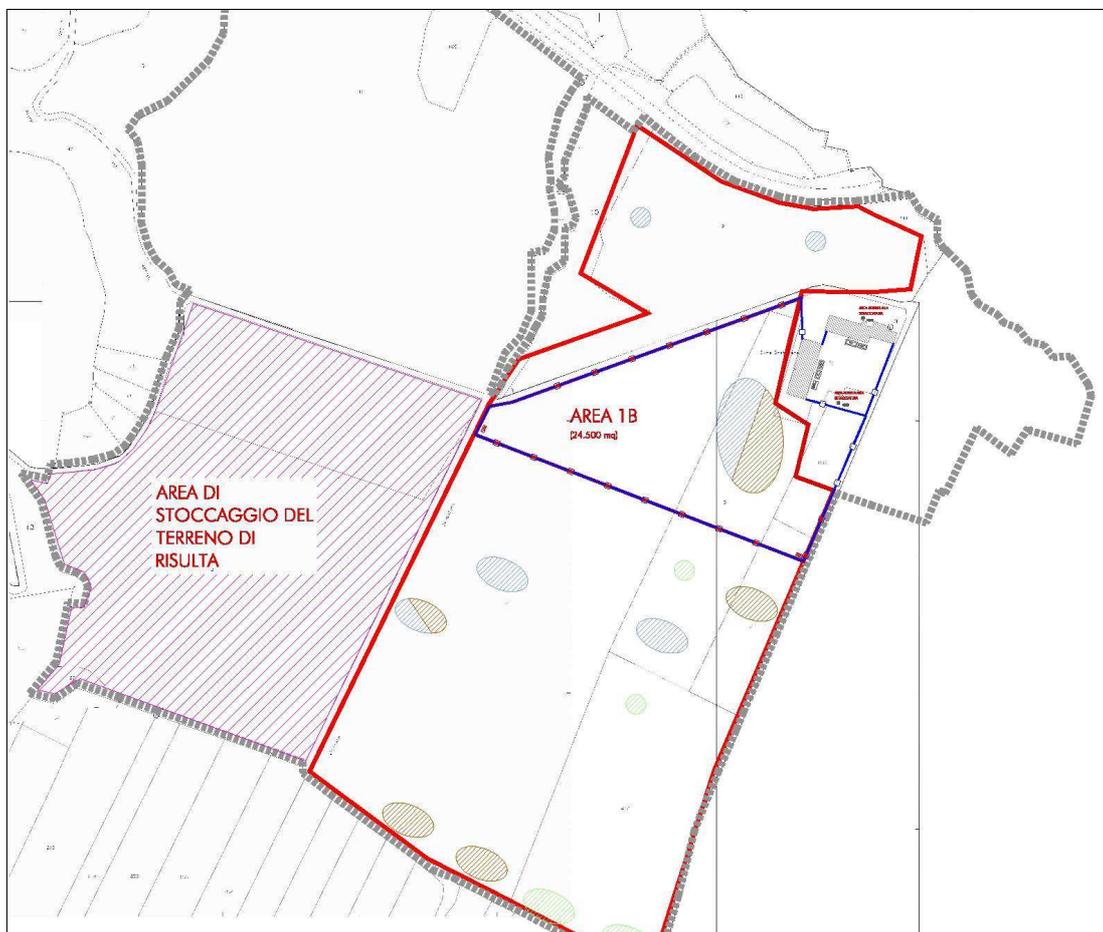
Planimetria generale della seconda fase di scavo – Area 1B
